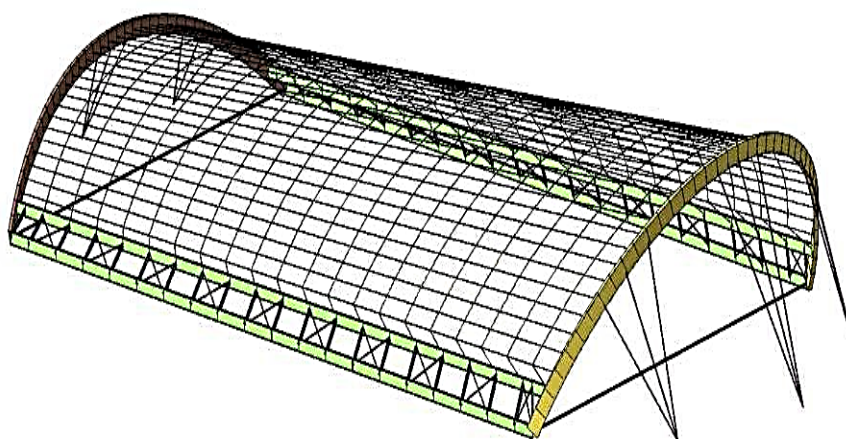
3-D схема будівлі з підібраними перерізами
